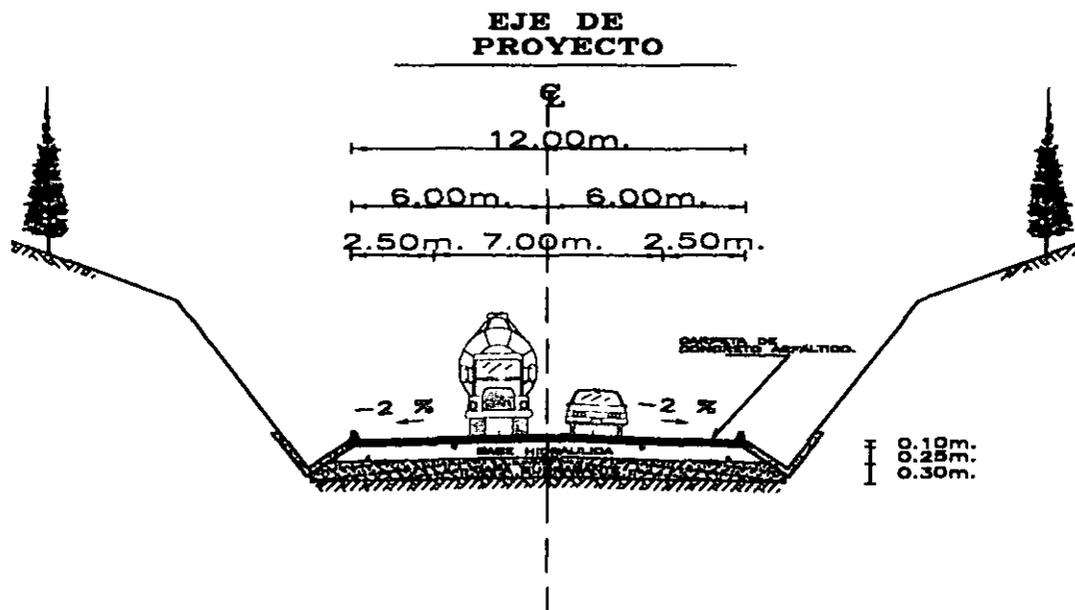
SECCIÓN TIPO ESTRUCTURAL EN BALCON.
